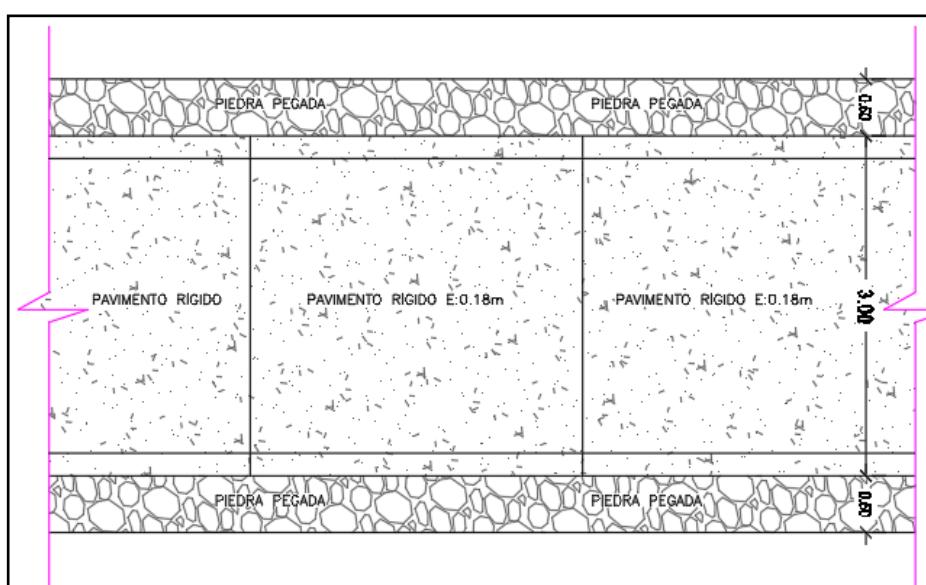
Esquema en planta de placa de aproximación (Tramos: K3+960, K4+000, K4+023 y K4+050).
